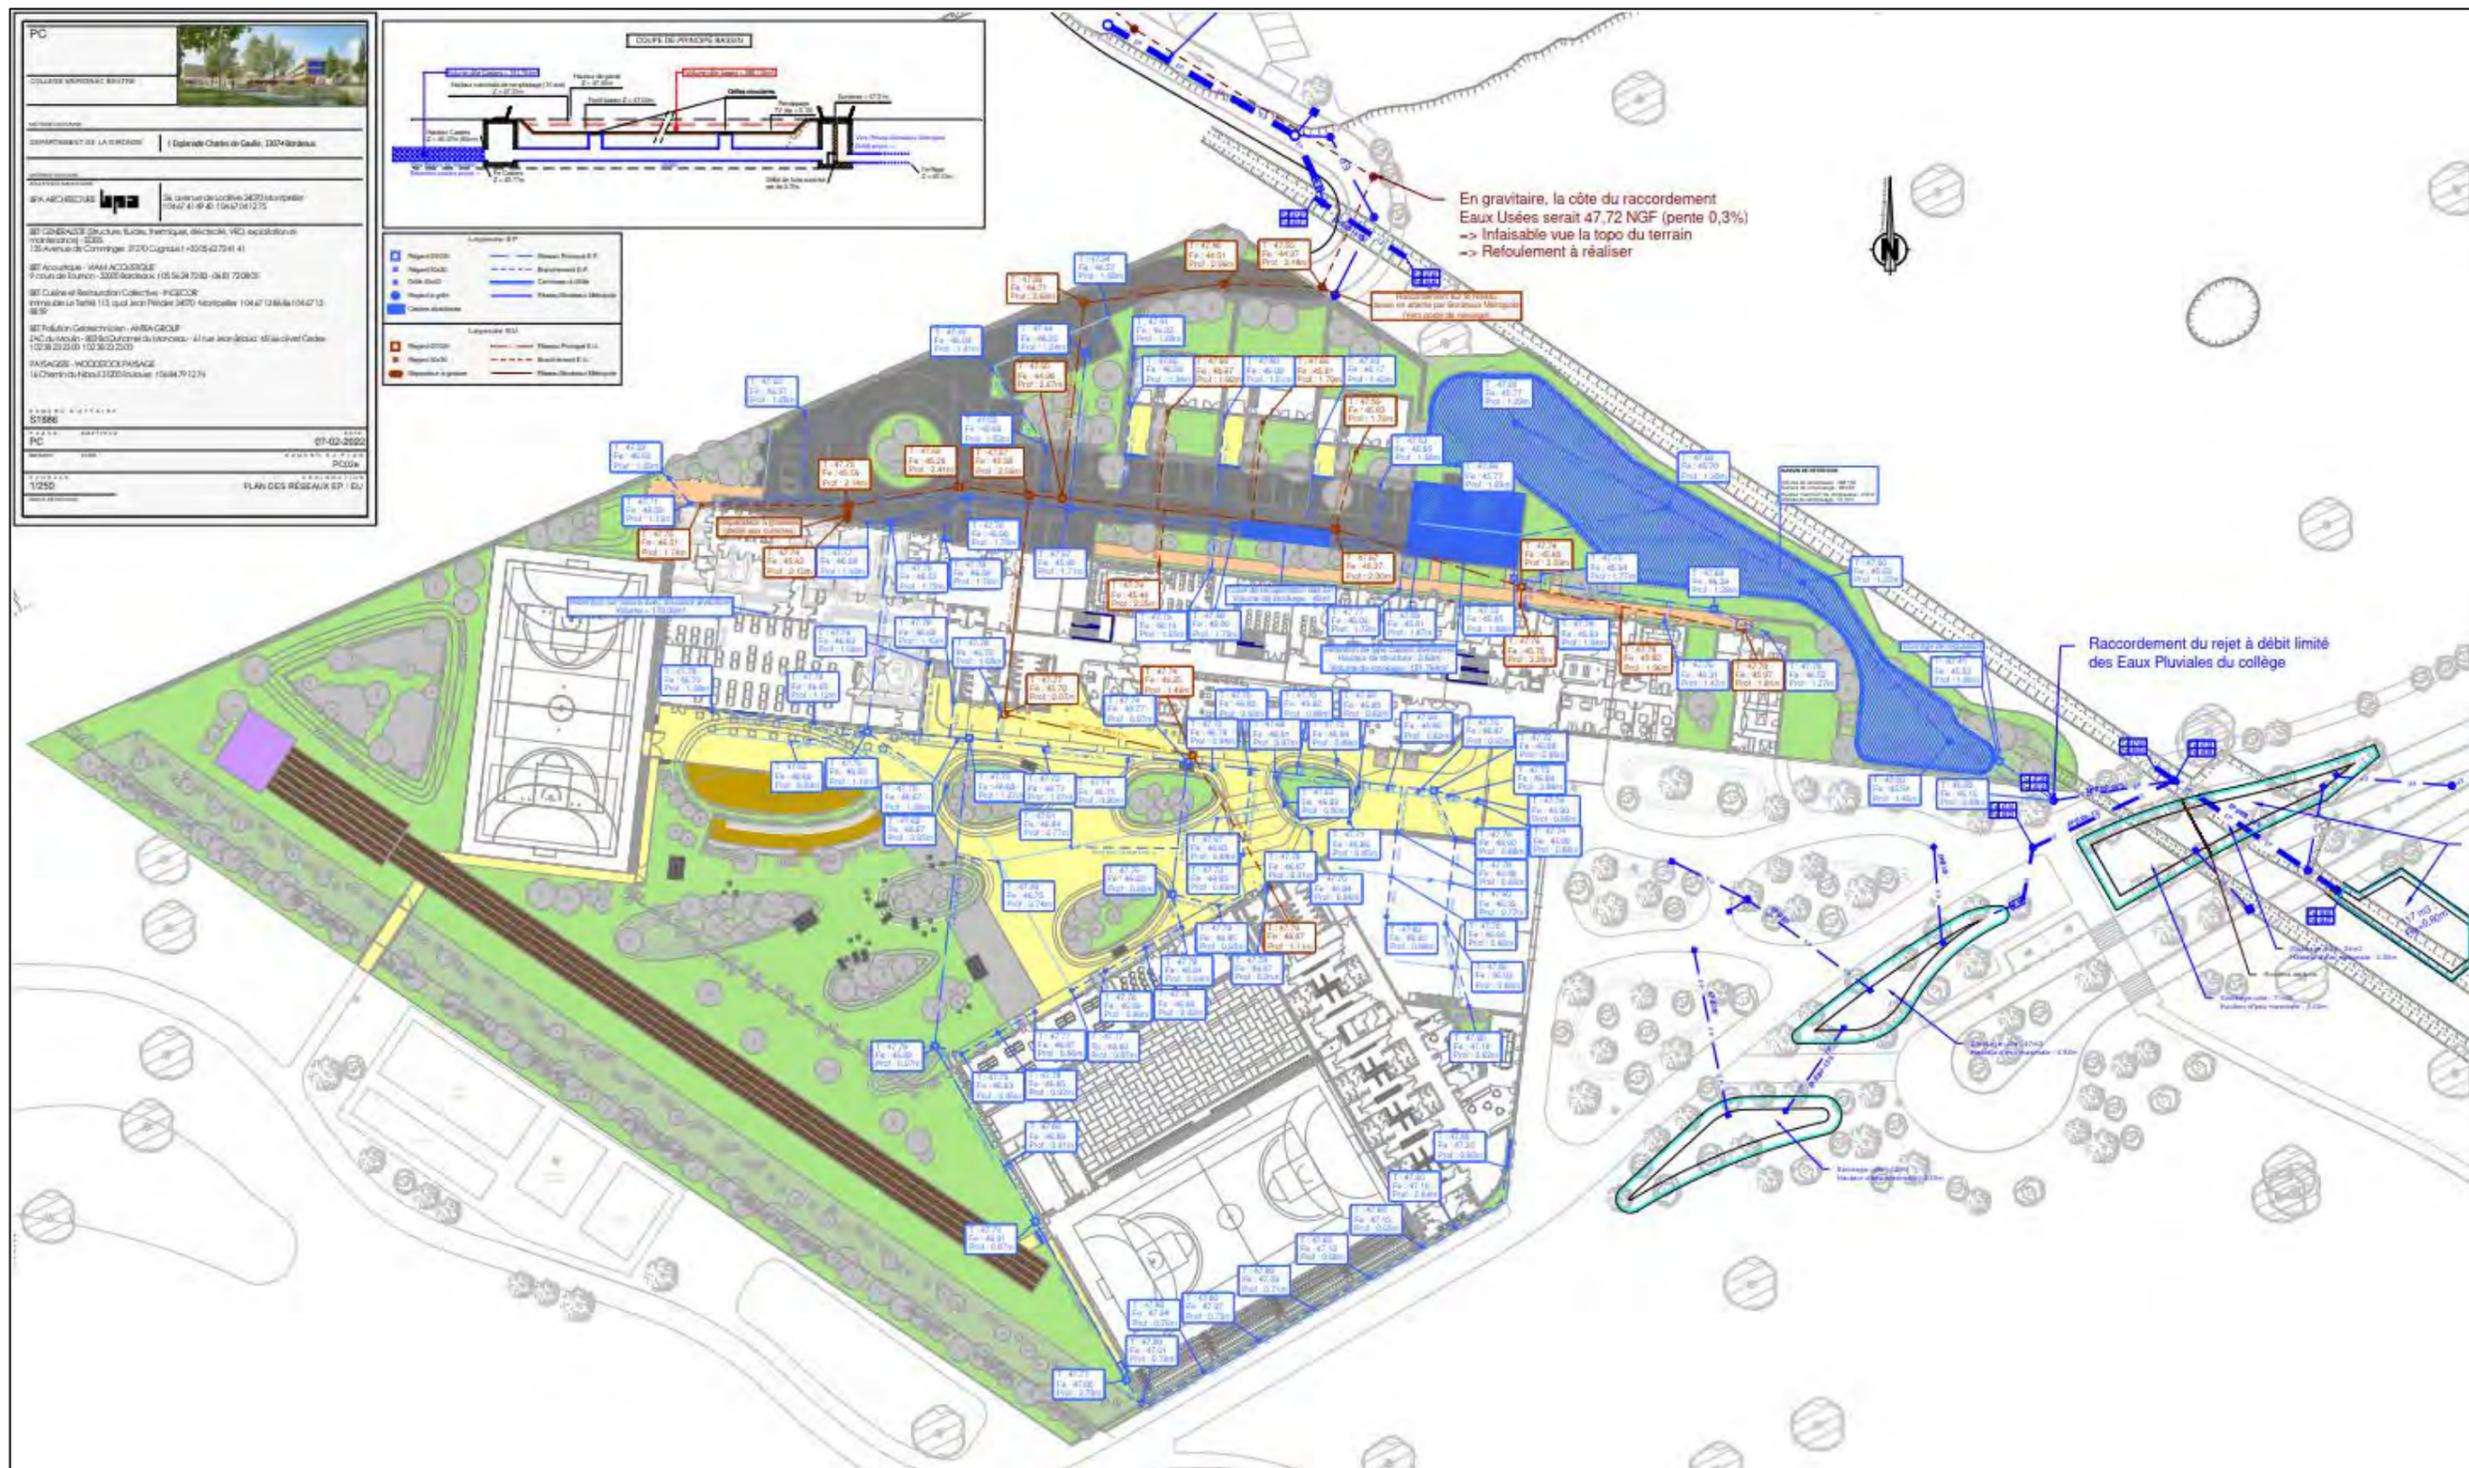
Plan des réseaux eaux pluviales / eaux usés
